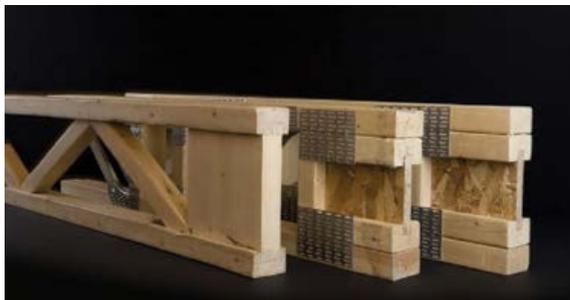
• Bout ajustable d'une poutrelle ajourée à connecteurs métalliques
